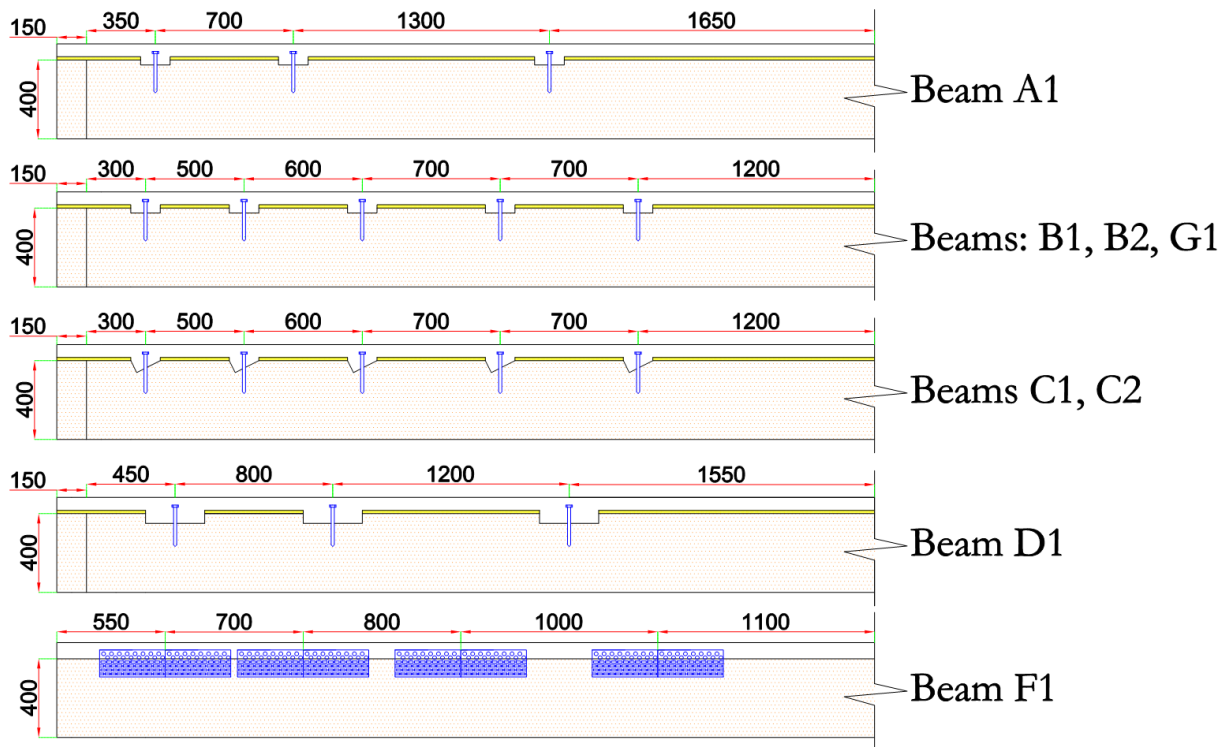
Les poutres BBC testées par Yeoh et al [43] (dimensions en mm).
